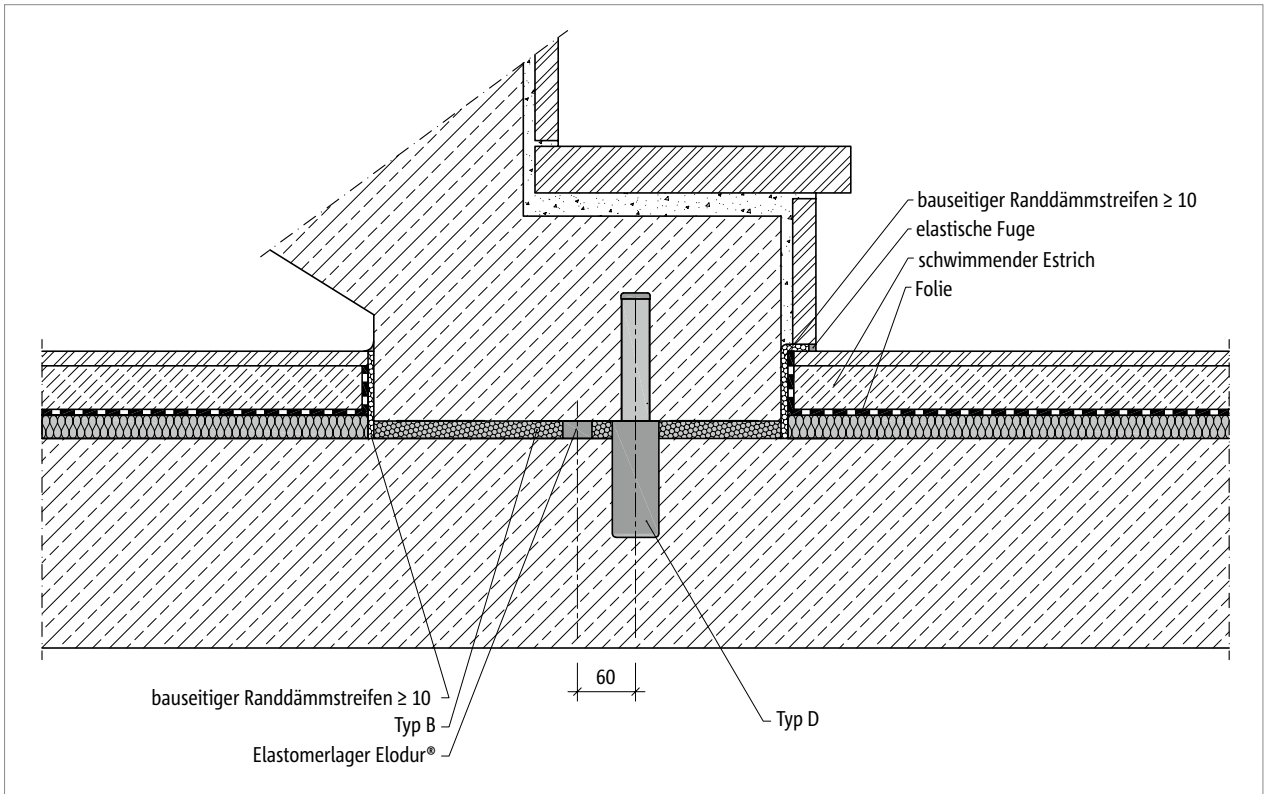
Schöck Tronsole® Typ B + Typ D: Alternative Installation
